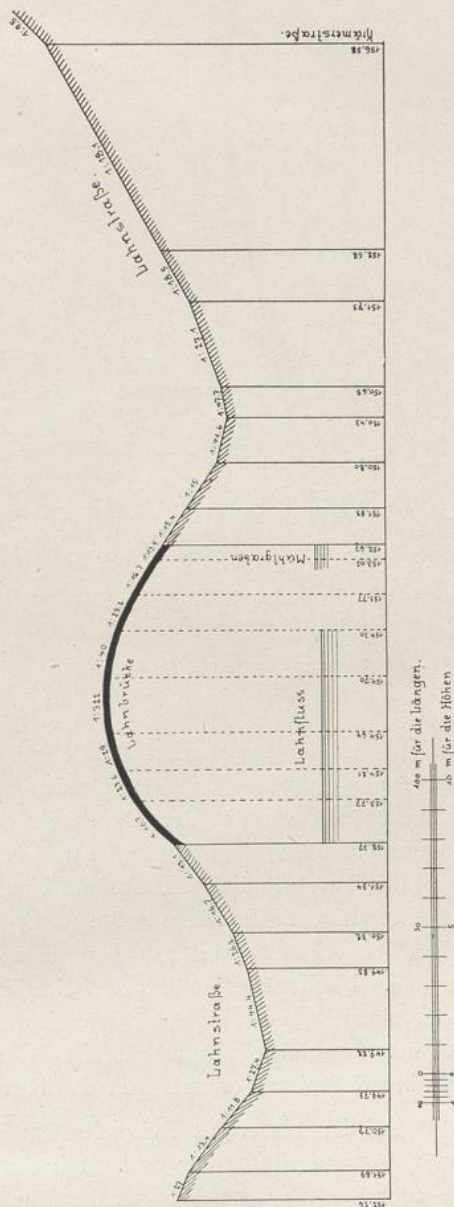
Verbindung der Brücke mit den Zufahrtsstraßen (Wezlar, Lahnstraße).
